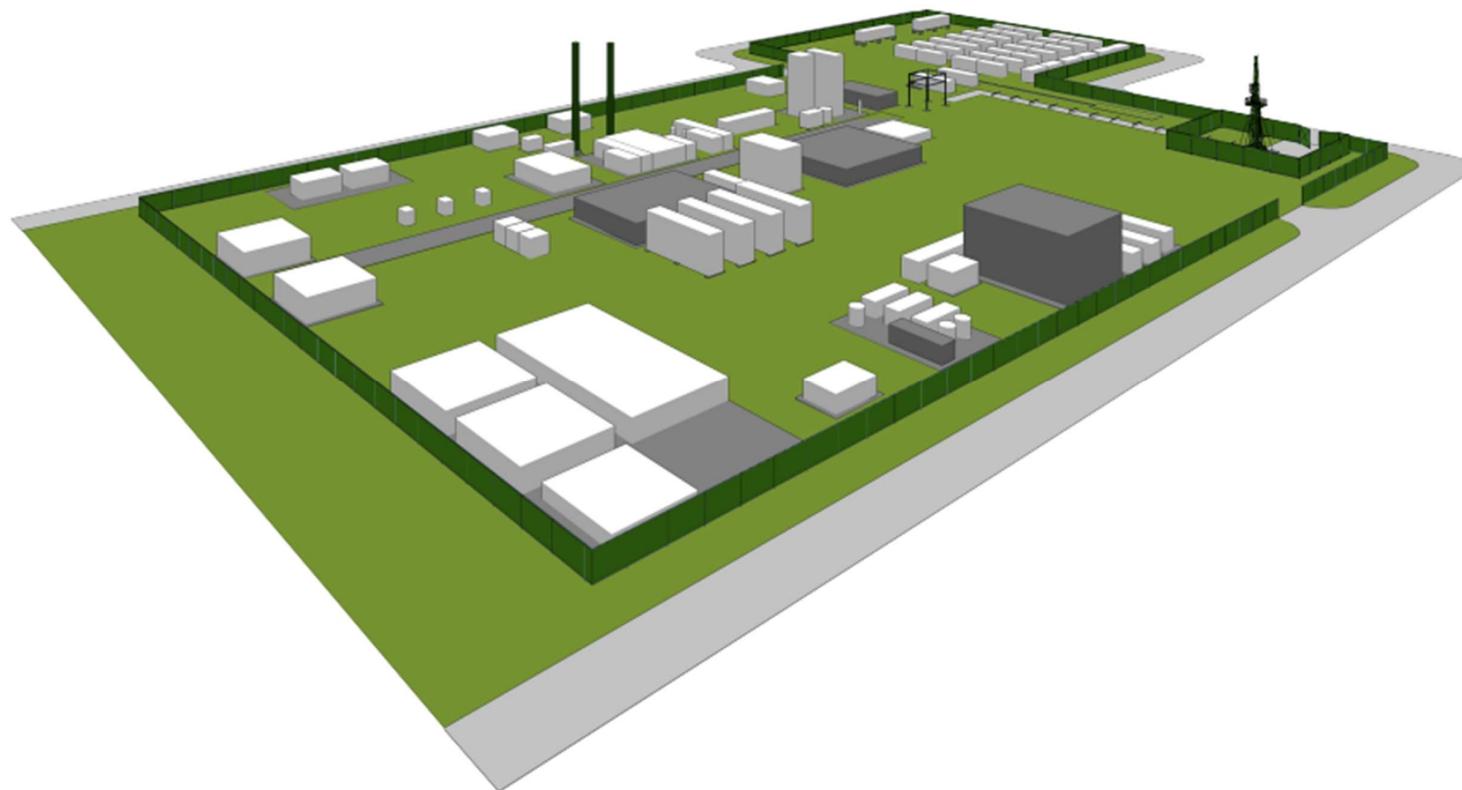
RENDERING 3D DELL'IMPIANTO (FORNITO DALLA COMMITTENTE)
